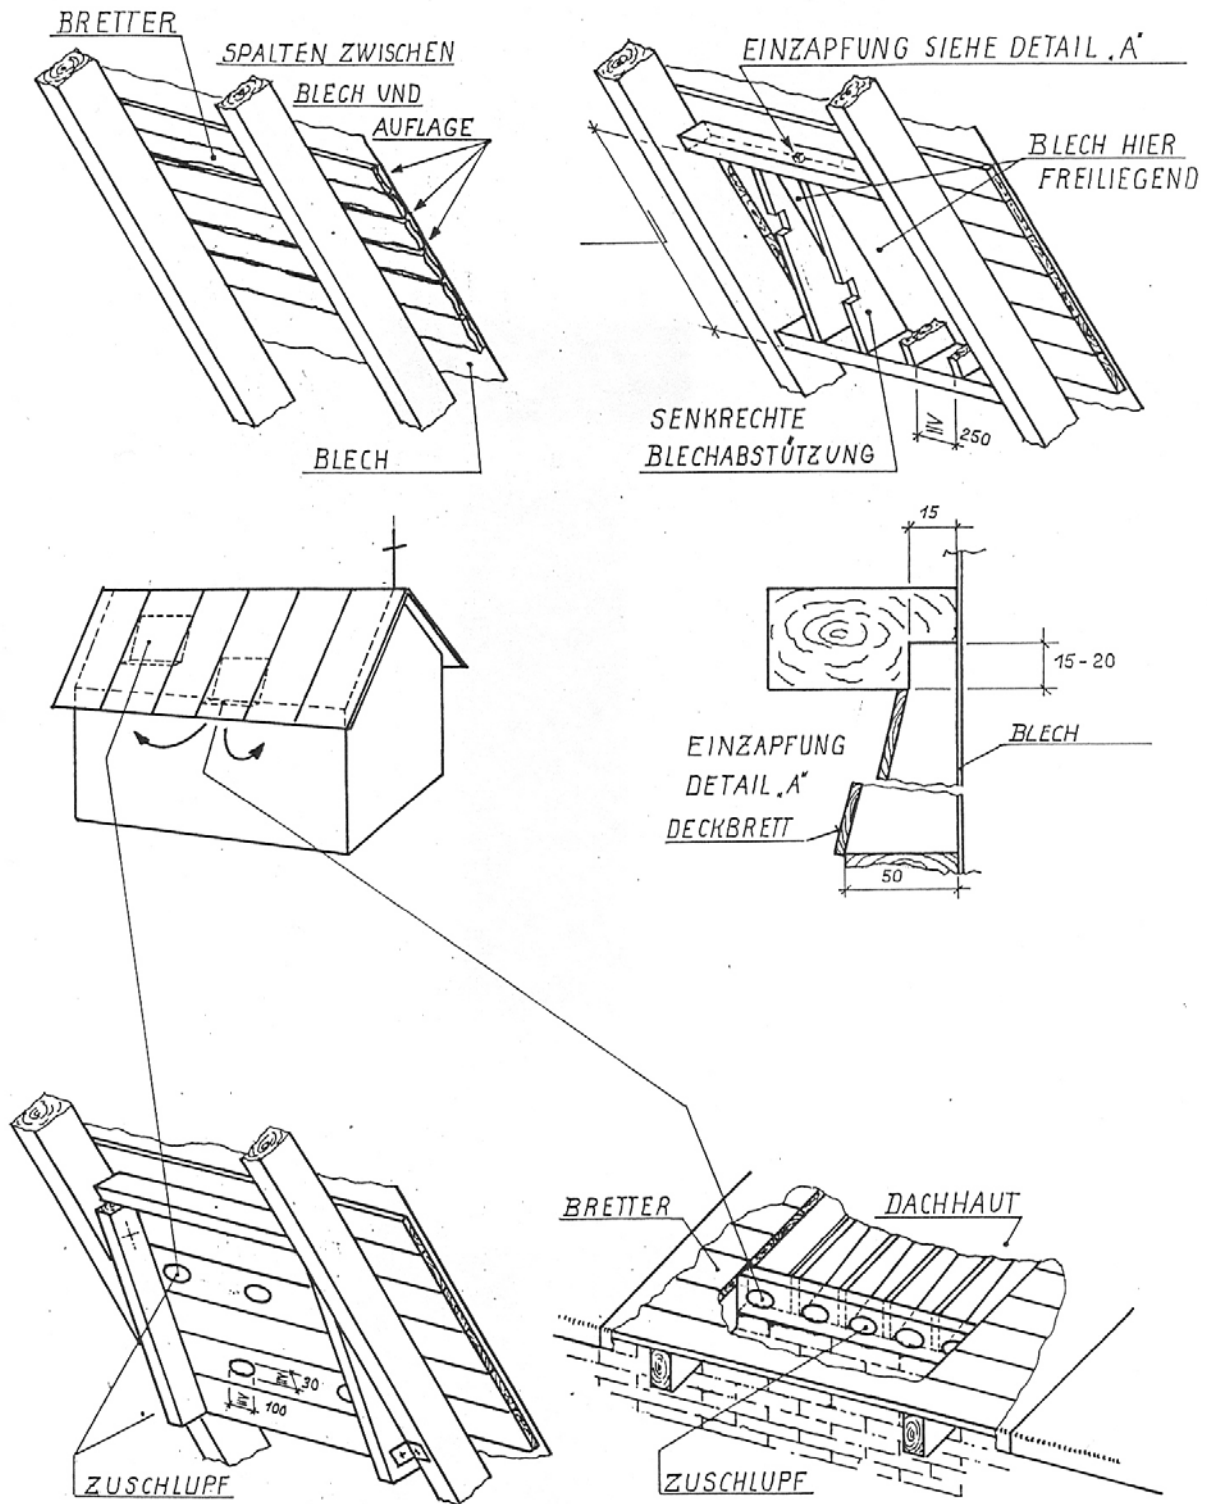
Konstruktion eines Fledermausverstecks unter einem Blechdach. Links oben: ursprüngliches Versteck zwischen altem Blech (verformt) und Dachlatten. Rechts oben: Anbringung eines Spaltenverstecks zwischen zwei Dachbalken. Die Dachlatten werden in diesem Bereich entfernt, das Blech wird durch senkrechte Abstützungen getragen. Öffnungen auf der inneren Seite der Abstützungen erlauben es den Fledermäusen, die Abteile zu wechseln. Sie werden von innen mit Brettern abgedeckt (links unten). Da die Abstützungen schräg geschnitten sind, verengt sich das Quartier nach oben zu und bietet so eine variable Spaltenbreite. Mitte links: Positionierung der Verstecke im Dachraum. Bei dem höher gelegenen Versteck erfolgt der Zuschluß vom Dachraum aus (links unten), bei dem tiefer gelegenen (rechts unten) zusätzlich von außen (Maßangaben in mm).
